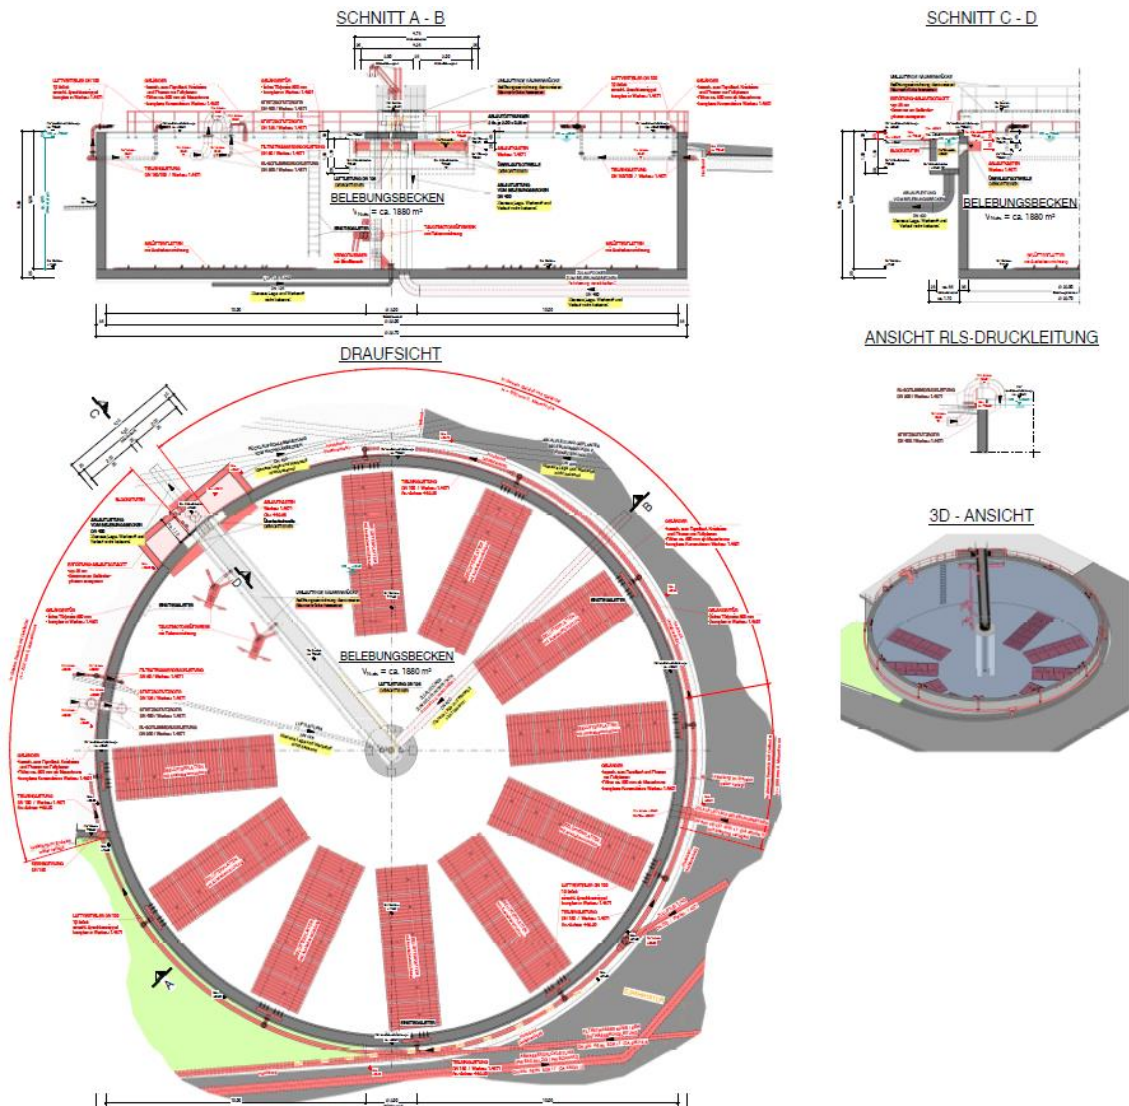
Planausschnitt Erneuerung der Belüftung (Stand 10/2020)
